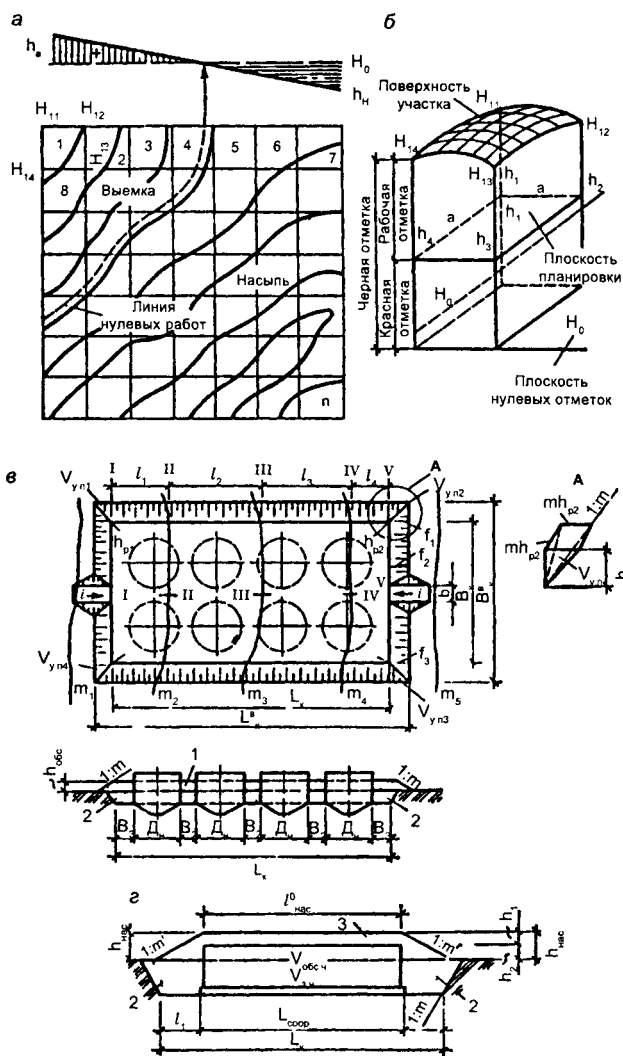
Схемы к подсчету объемов вертикальной планировки, засыпки и обсыпки сооружений:
